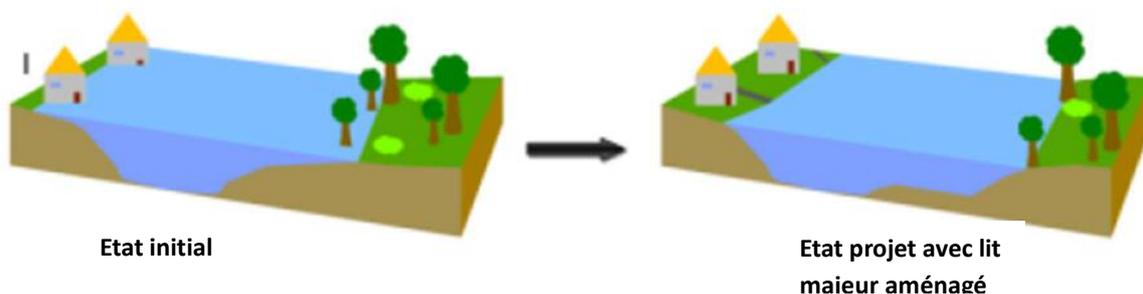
Schéma de principe d'une protection localisée de type décaissement
